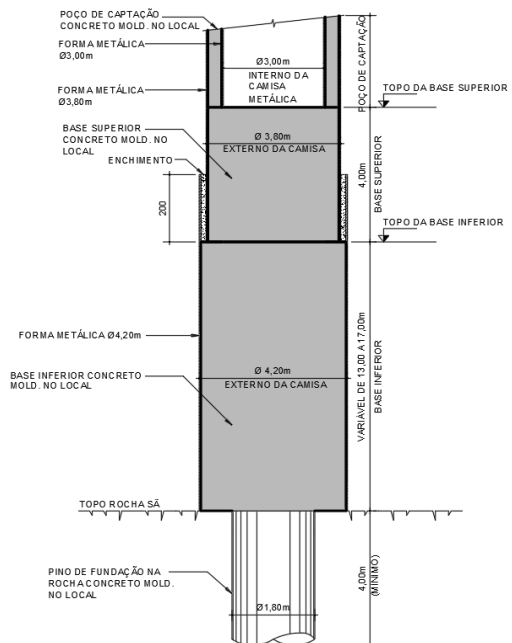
Corte transversal da estrutura de fundação do poço de captação
